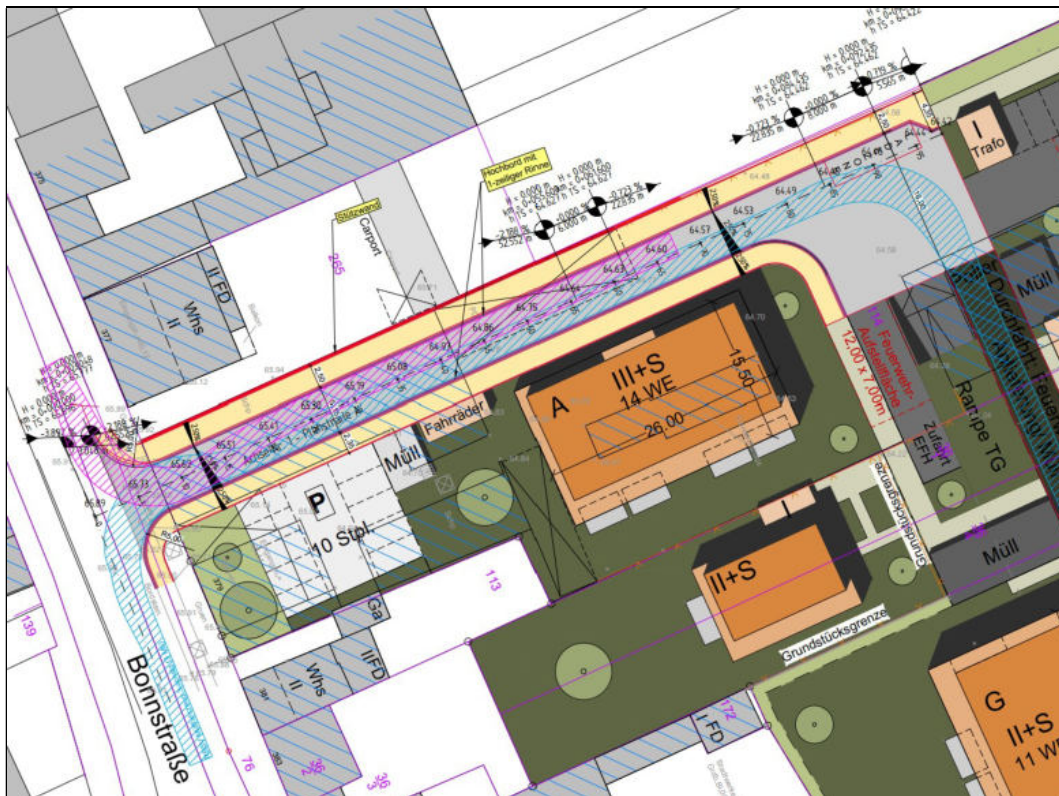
Vorentwurf Planstraße A (Ingenieurbüro Schmidt, 05/2025)
